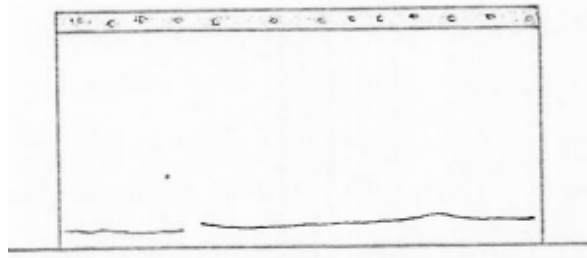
Fissuras típica por retração higroscópica.
